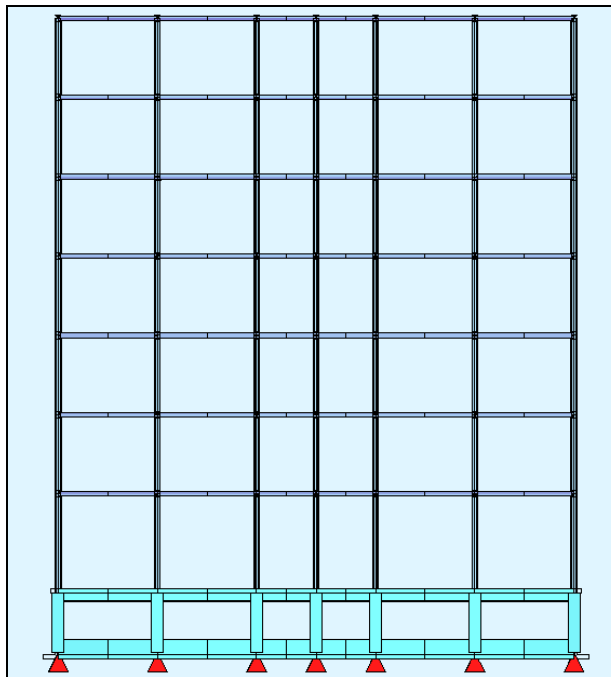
Βόρεια τομή κτιρίου TRUSS 2
